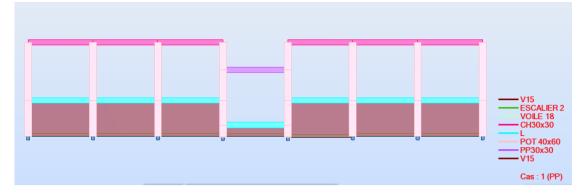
schéma des voiles périphériques longitudinales avec les poteaux et les poutres
